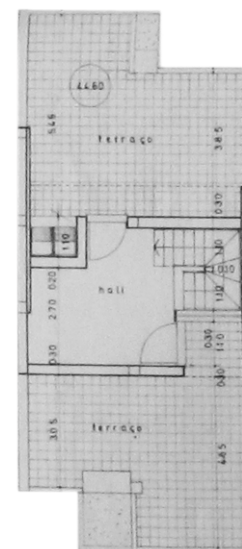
12 Plantas do fogo T4 triplex. Escala 1:200.
